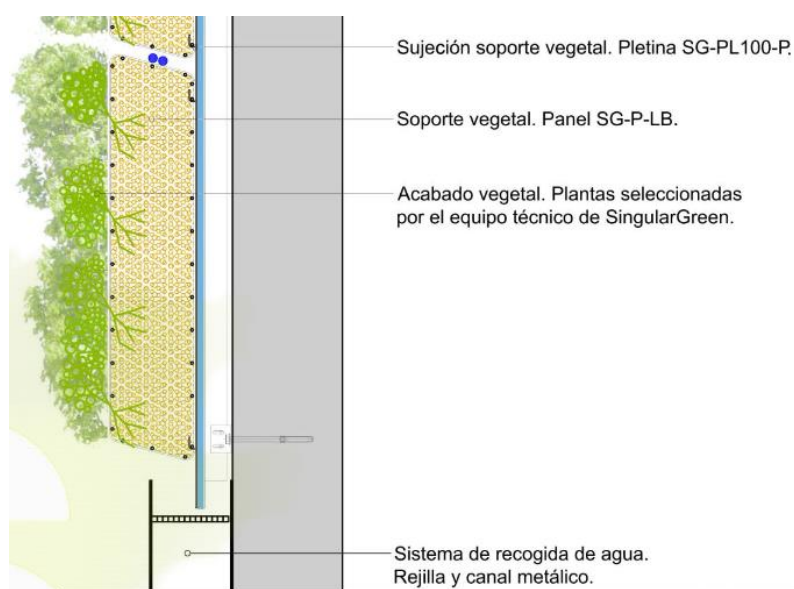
Detall constructiu del sistema LEAF BOX.
